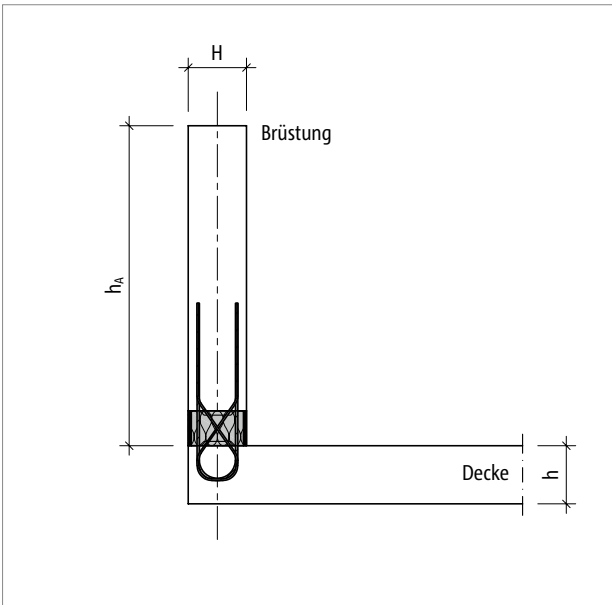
Schöck Isokorb® XT/T Typ AP: Statisches System Brüstungshöhe h_n
